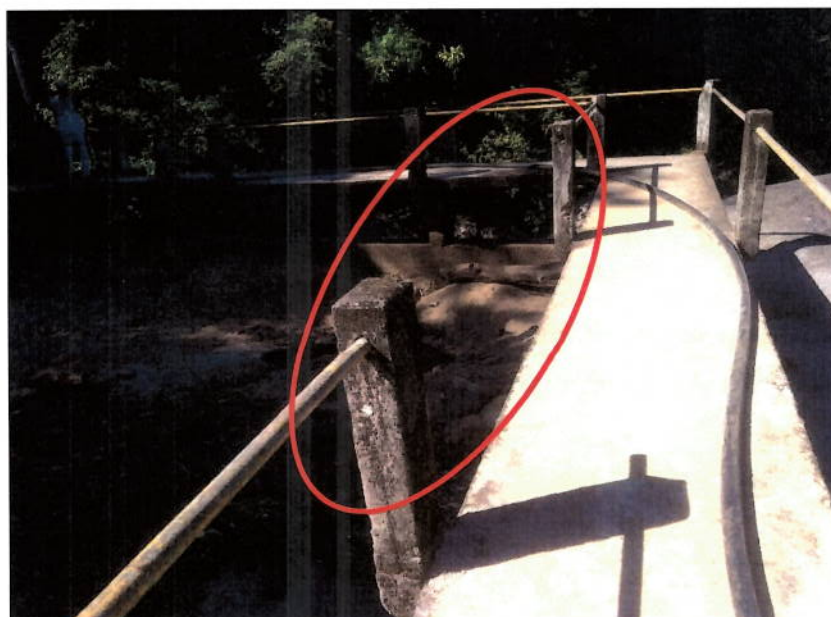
Parte do acesso à barragem sem guarda corpo.
